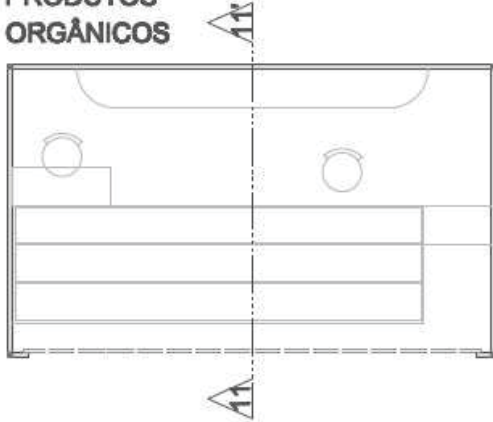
Boxes de 30m<sup>2</sup> - Layout e corte
